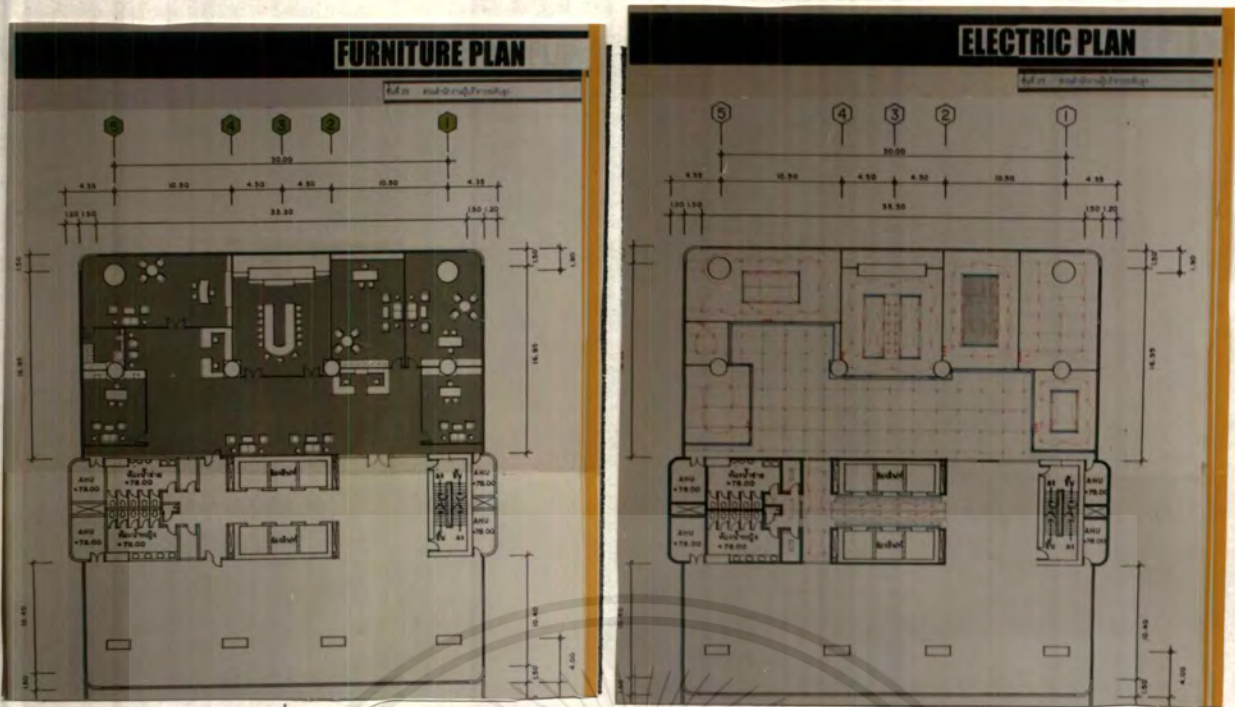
แสดง FURNITURE PLAN & ELECTRIC PLAN ชั้นที่ 27
